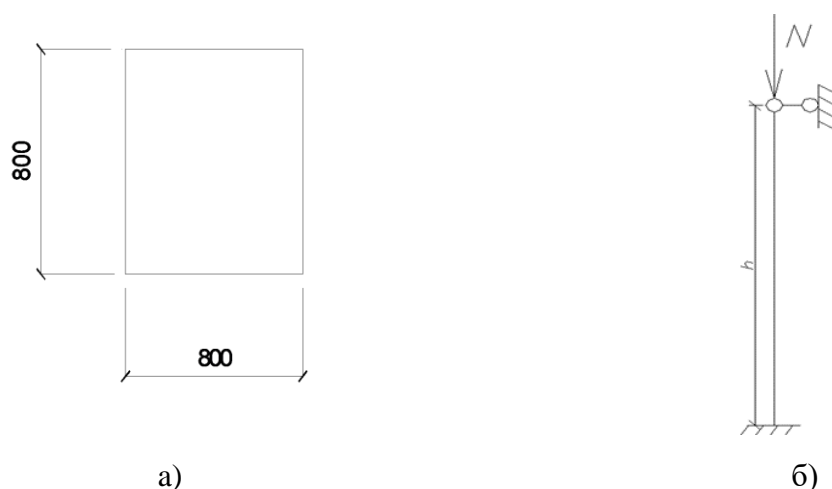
а) Геометричні параметри поперечного перерізу колони; б) Схема конструкції колони
